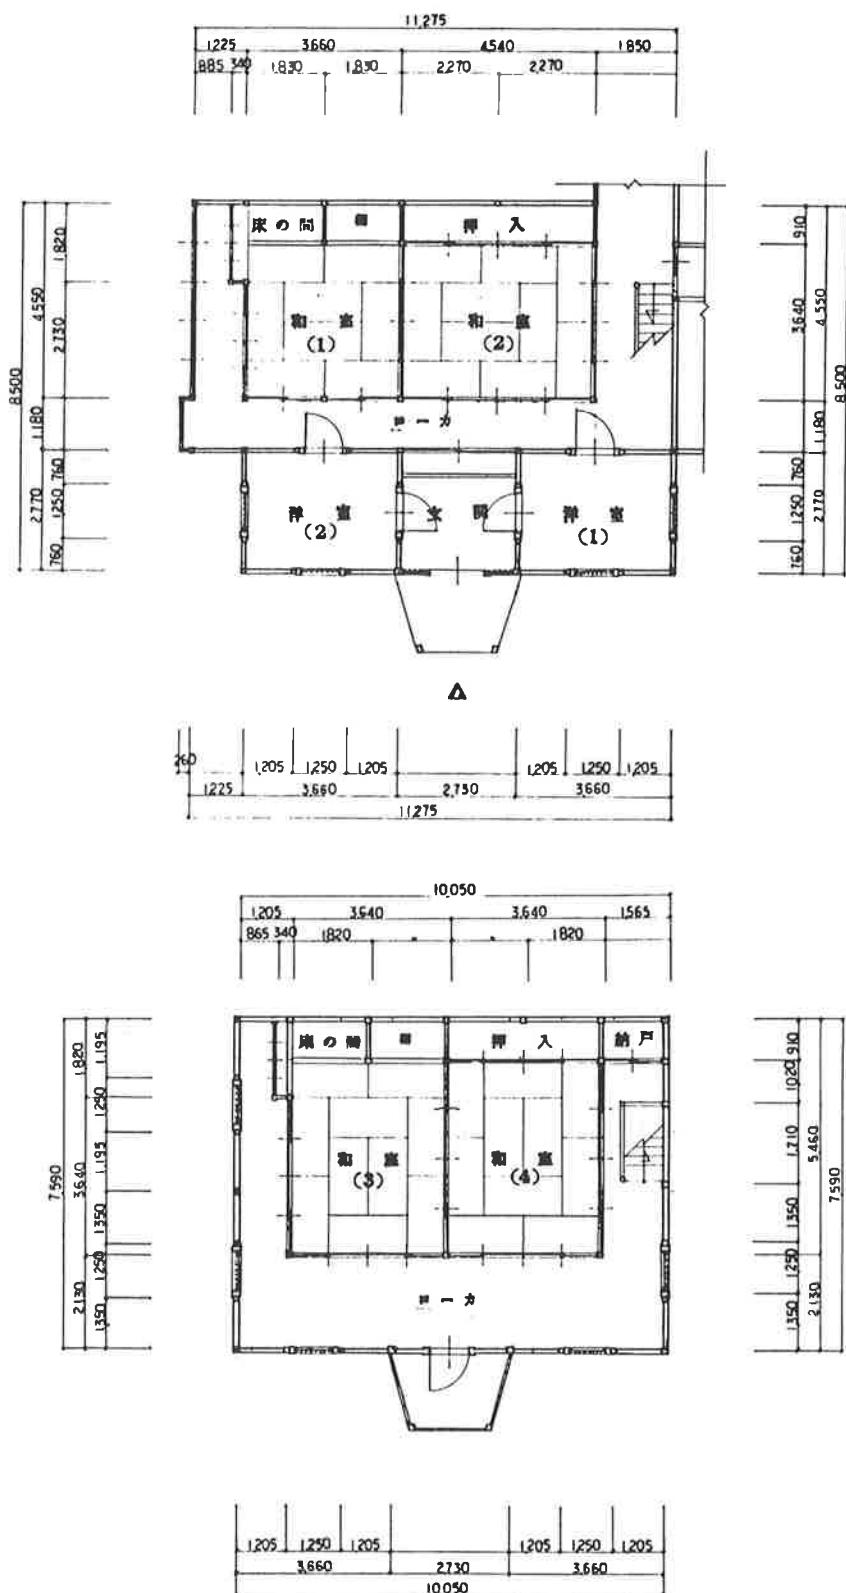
斎藤牧場事務所 1階平面図(上)、2階平面図(下)(北海道建築士会十勝支部東十勝分会実測作図)
